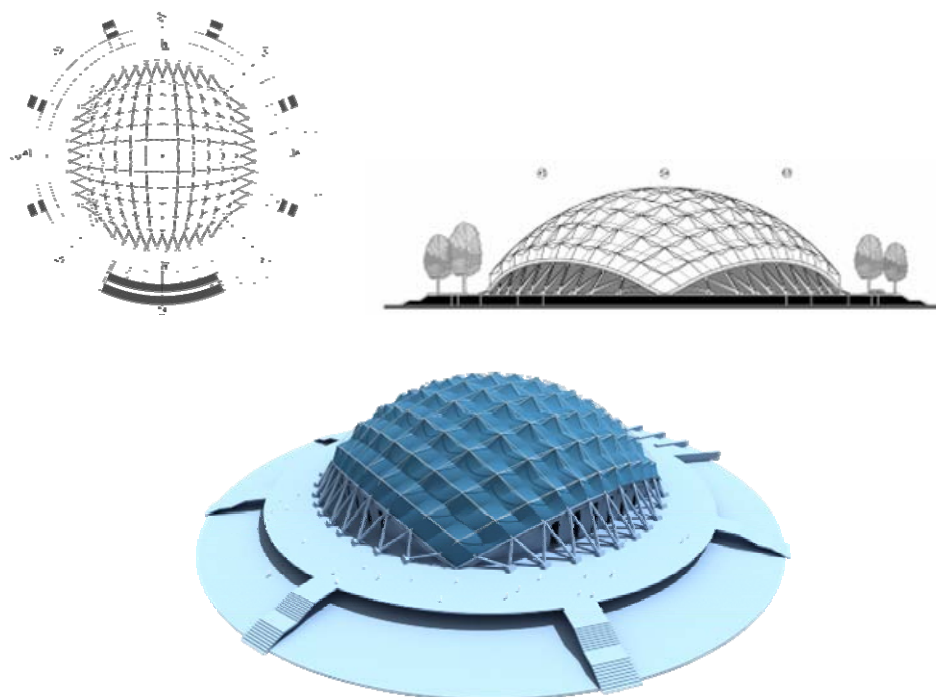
Planta, alzado y perspectiva digitales que ilustran el conjunto arquitectónico
